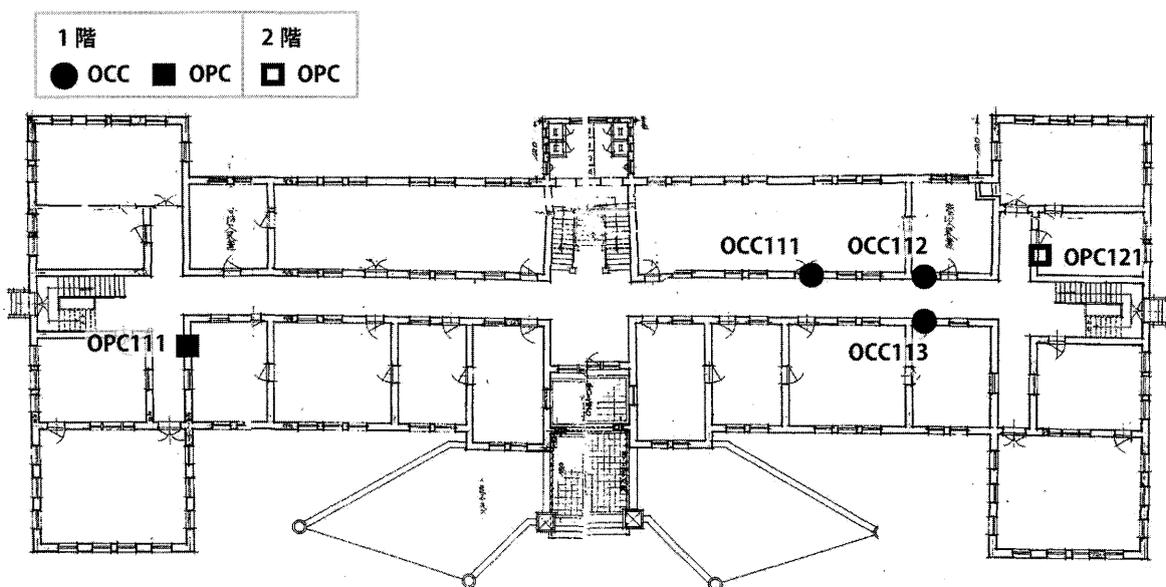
九州大学本部第一庁舎平面図（試験体採取位置）
